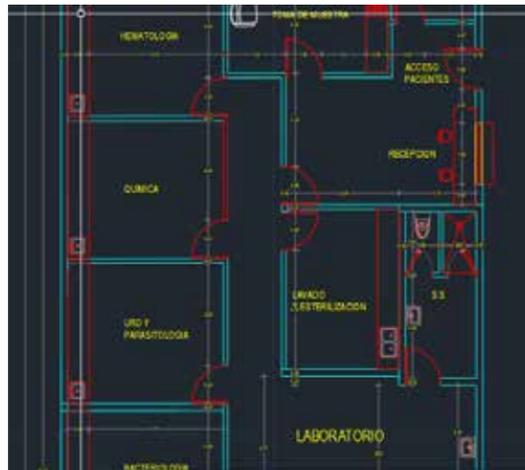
Plano acotado en AutoCAD Elaboración propia
